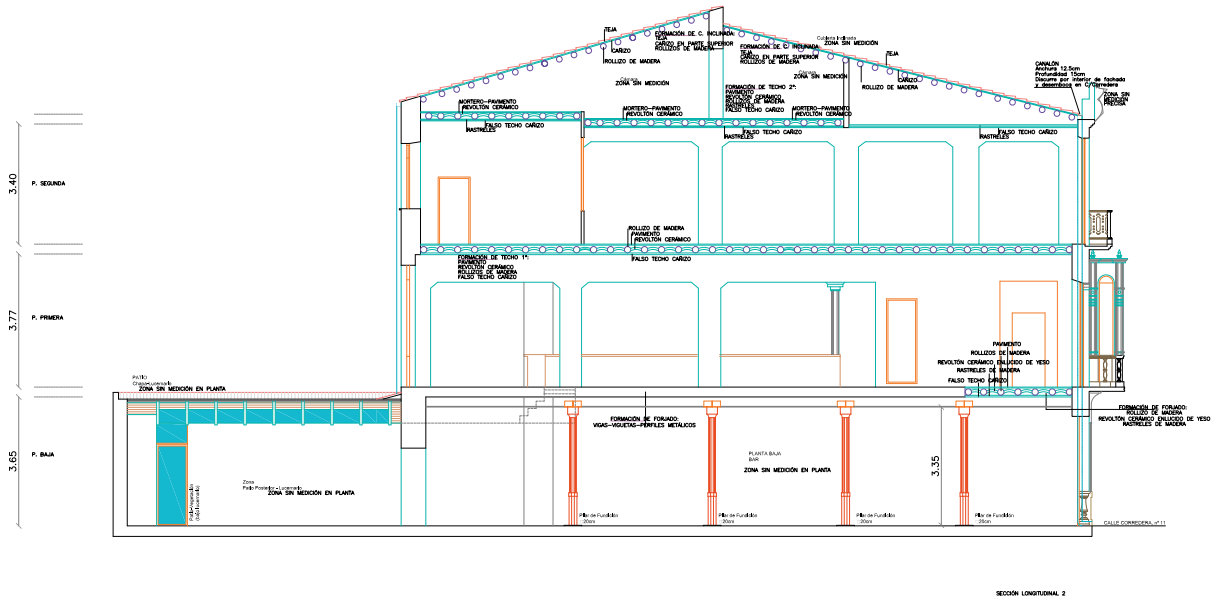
Actuaciones en cubierta y forjados. Sección longitudinal.
